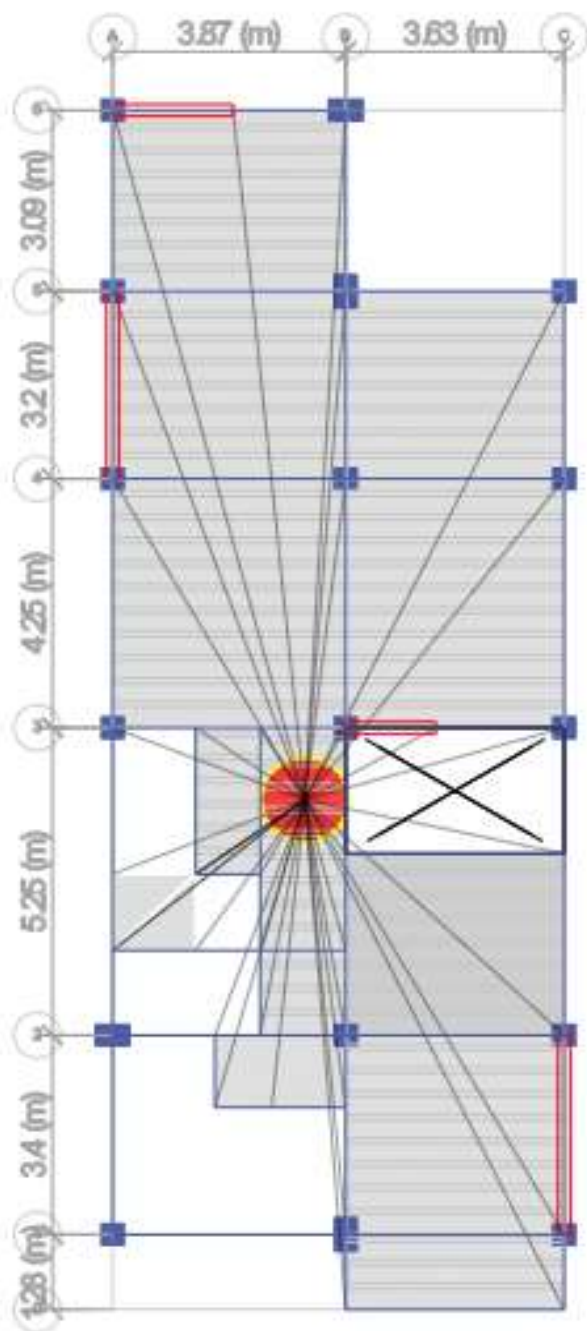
Vista en Planta del Diafragma Rígido del 1er piso
